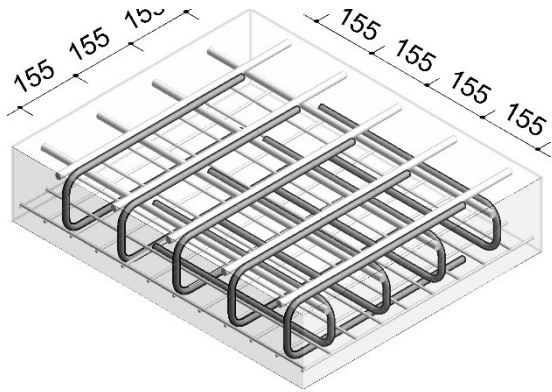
Detalhe da disposição dos ganchos nas bordas da laje.
